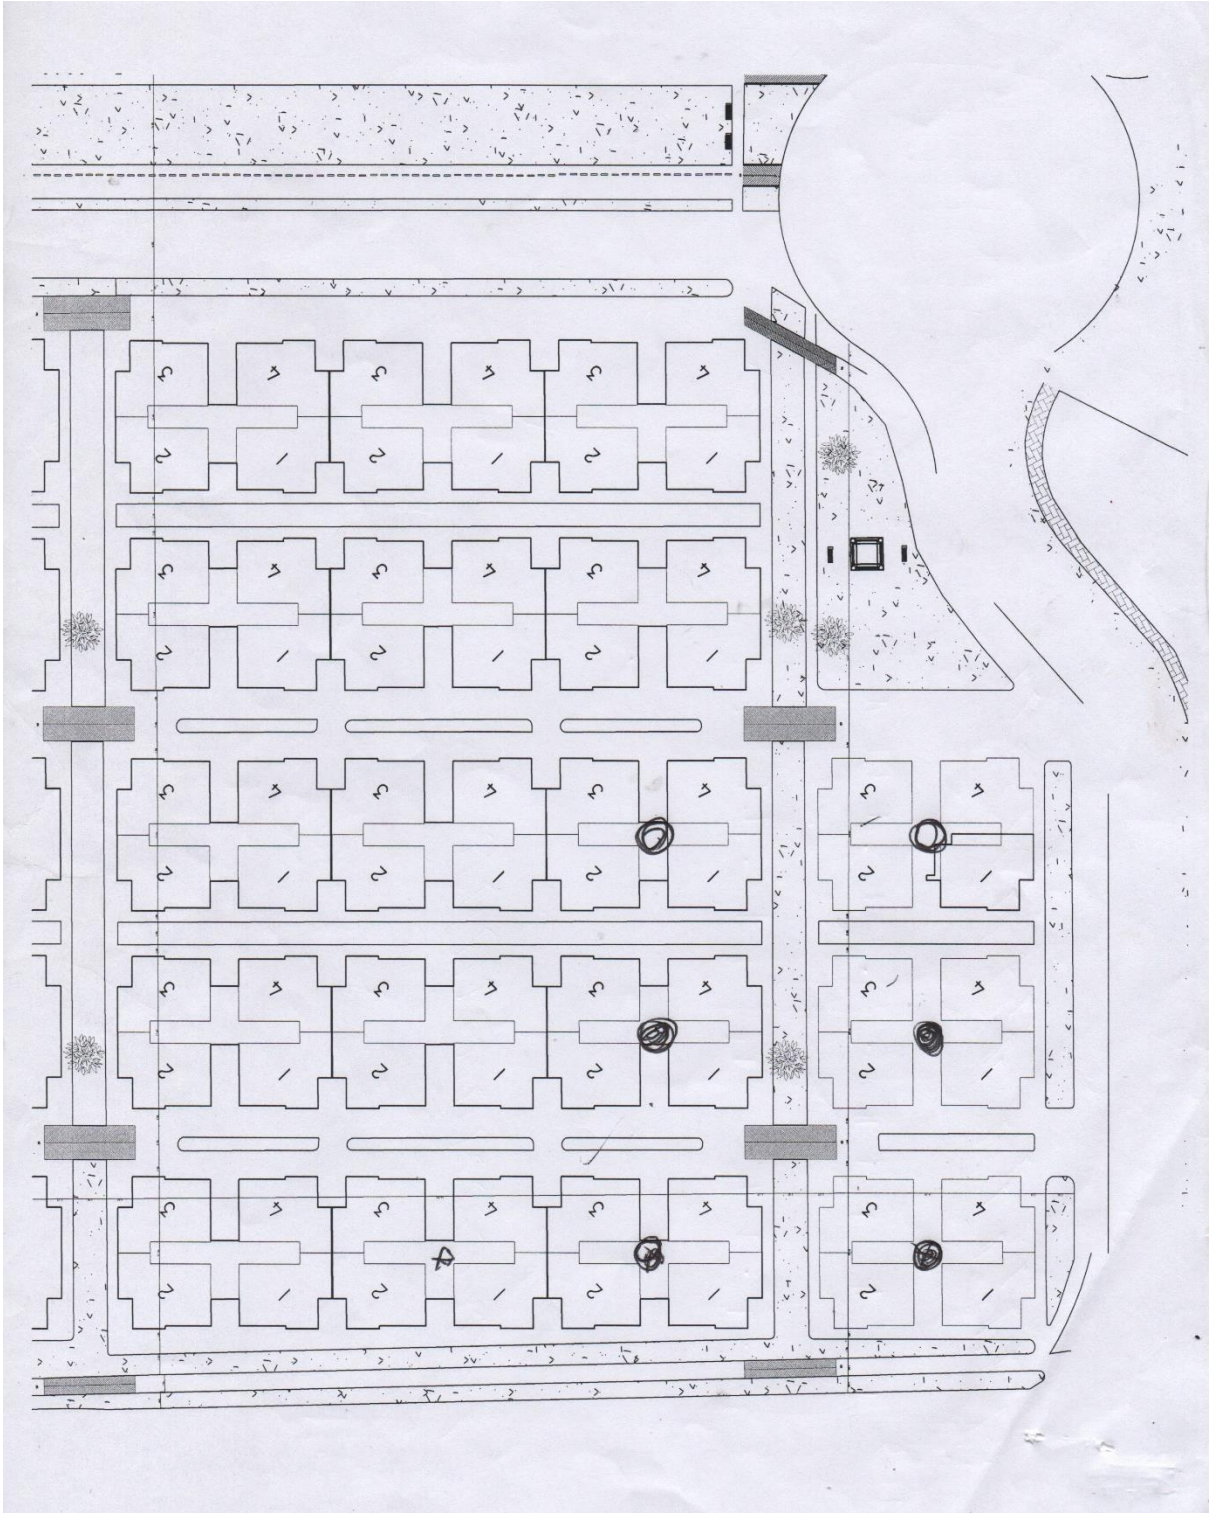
, Bloques escogidos para el trabajo de campo. Fuente: Elaboración Propia
